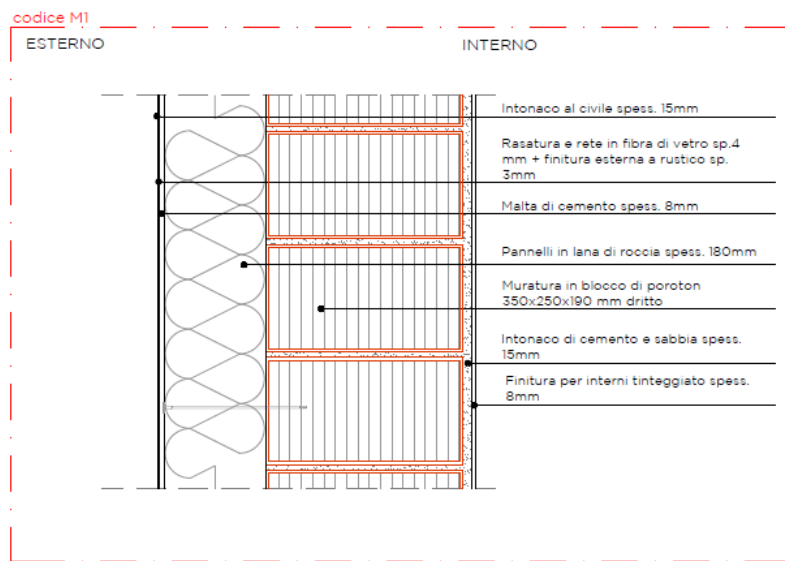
Dettaglio costruttivo muratura perimetrale. Tav.04.1 Stato di progetto_Pianta e dettagli
